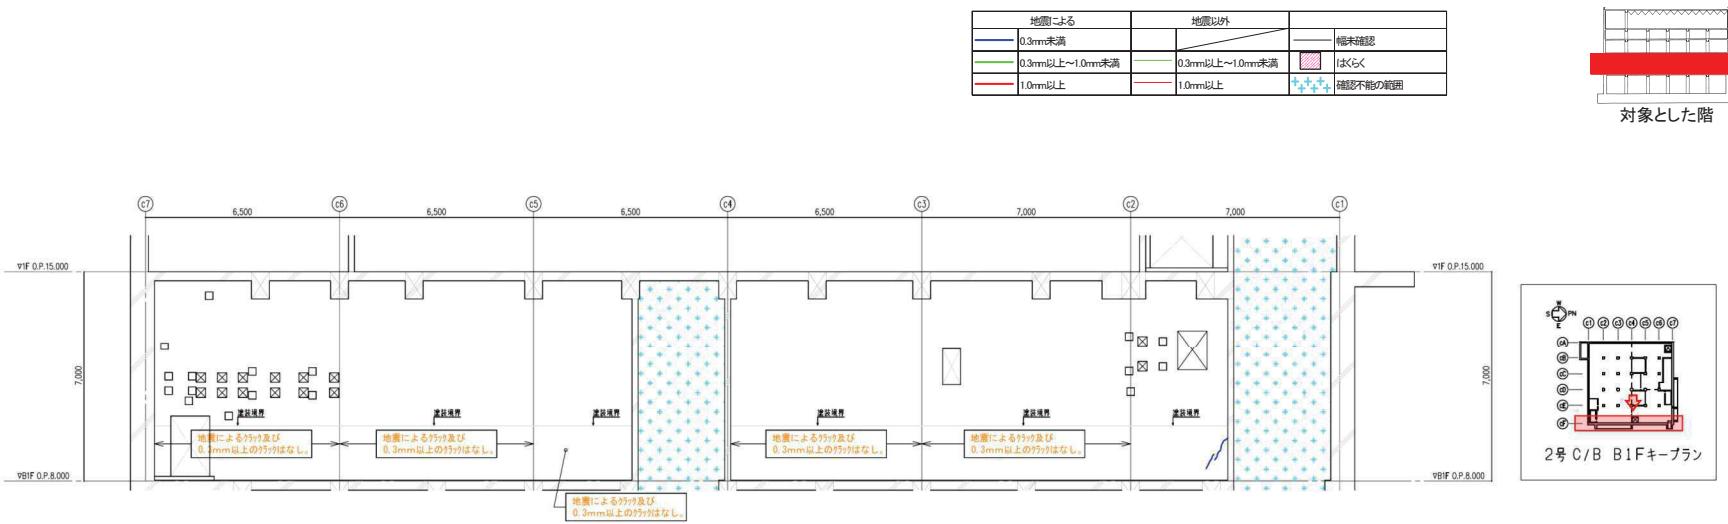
(1) 制御建屋のひび割れ分布（耐震壁 地下 1 階 CF 通り）
